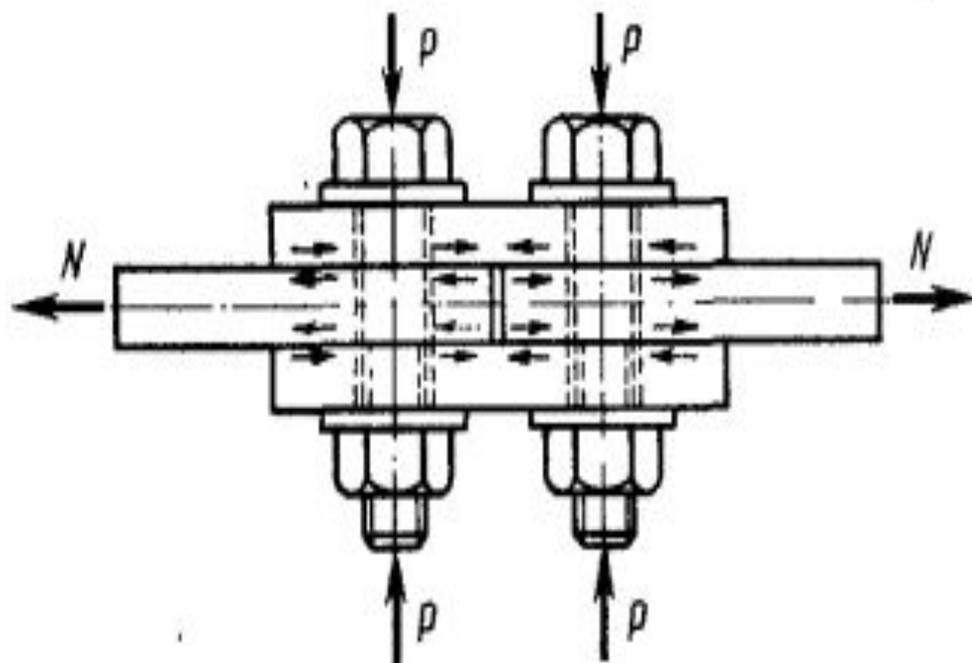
Схема работы соединения на высокопрочных болтах .
